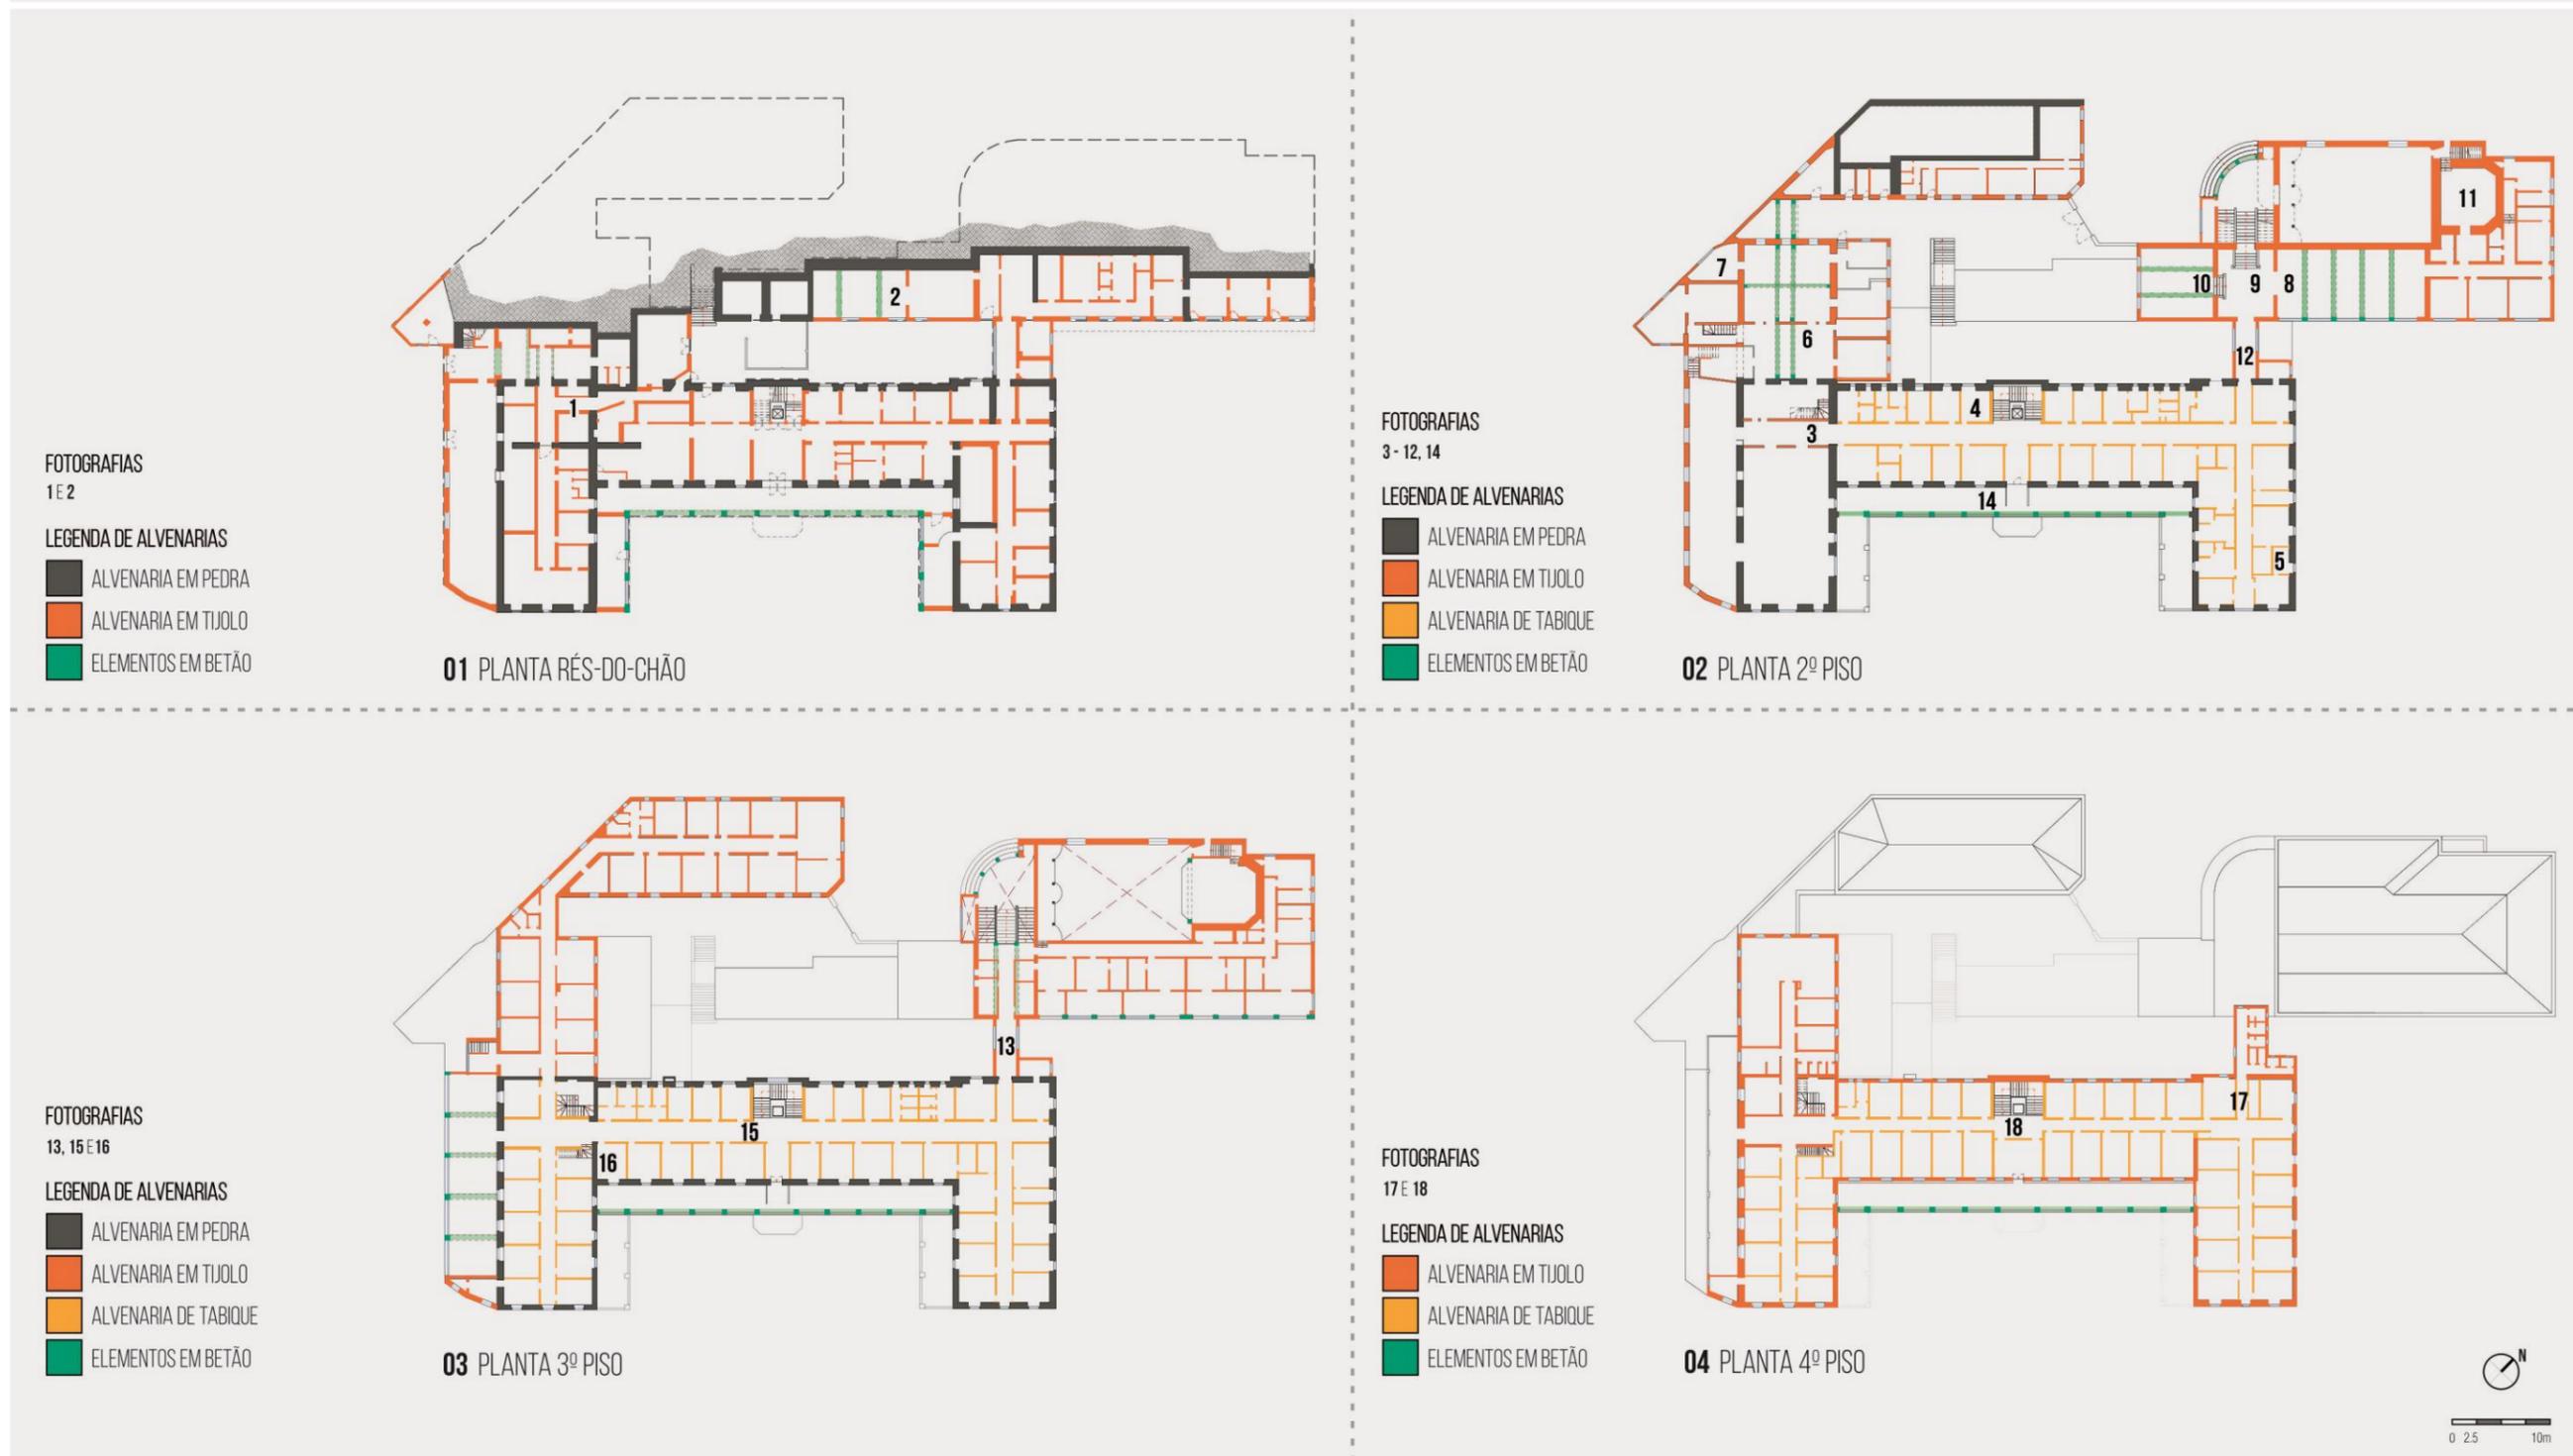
Definição construtiva – classificação das alvenarias e outros elementos estruturais (desenvolvida a partir da cópia da planta original)
